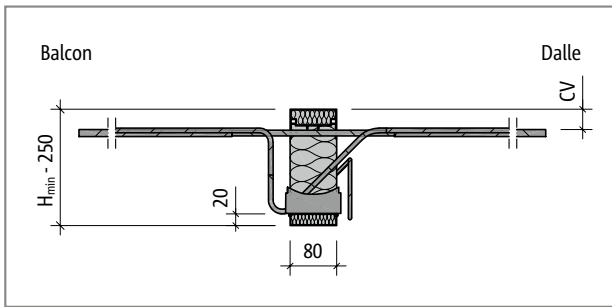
Schöck Isokorb® T Type K-E-M6, K-T-M7, -M9, -M10 : Coupe du produit
